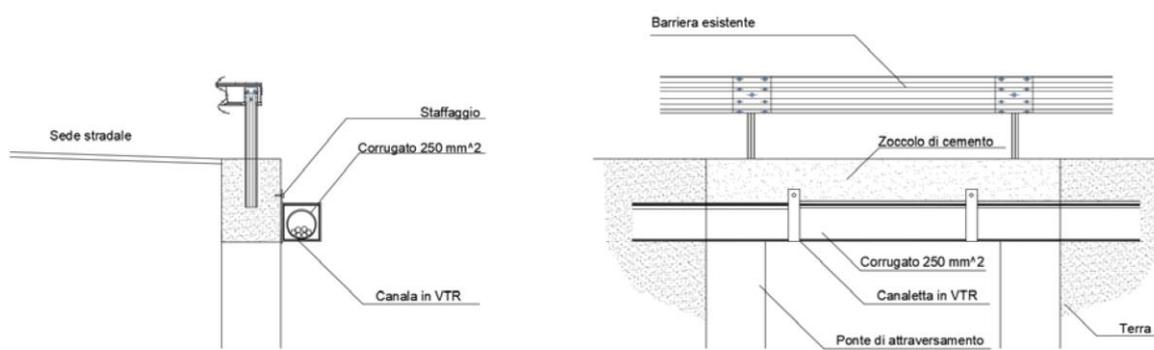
Sezione tipo dello staffaggio del cavidotto ad un ponte stradale
